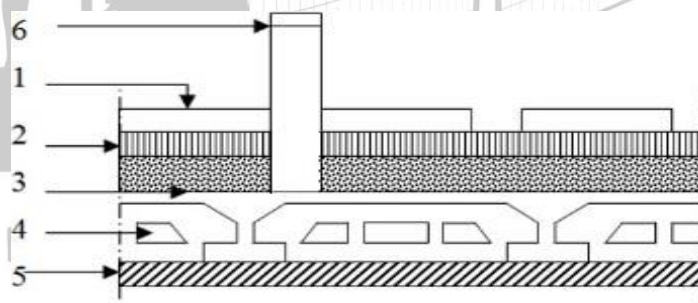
Coupe verticale du plancher étage courant.
